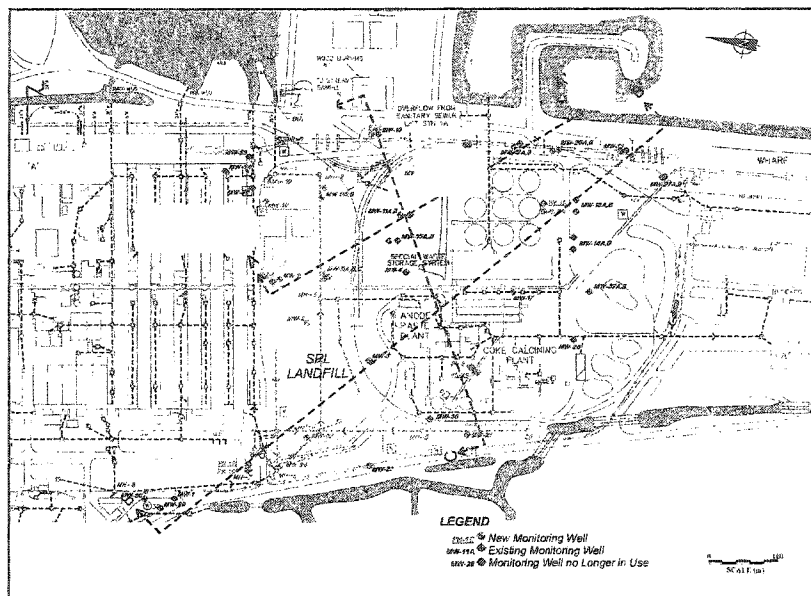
Plan du site d'enfouissement et identification des plans A-A, B-B et C-C.
